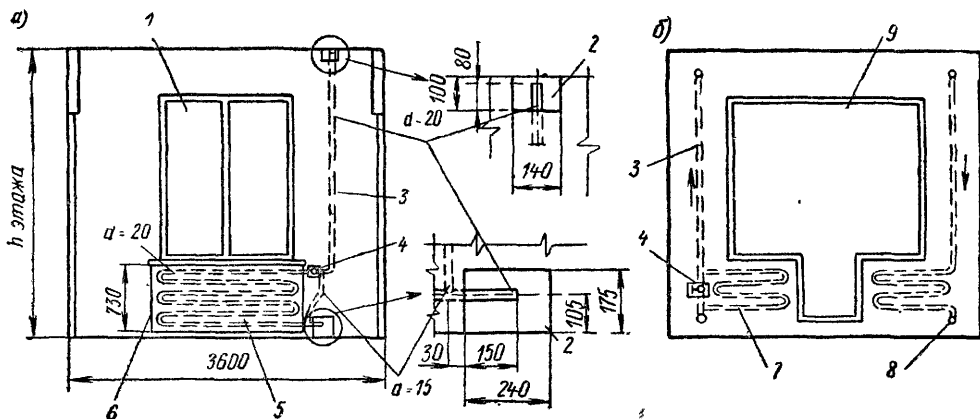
Наружные стены с отопительными стояками и подоконными бетонными панелями
